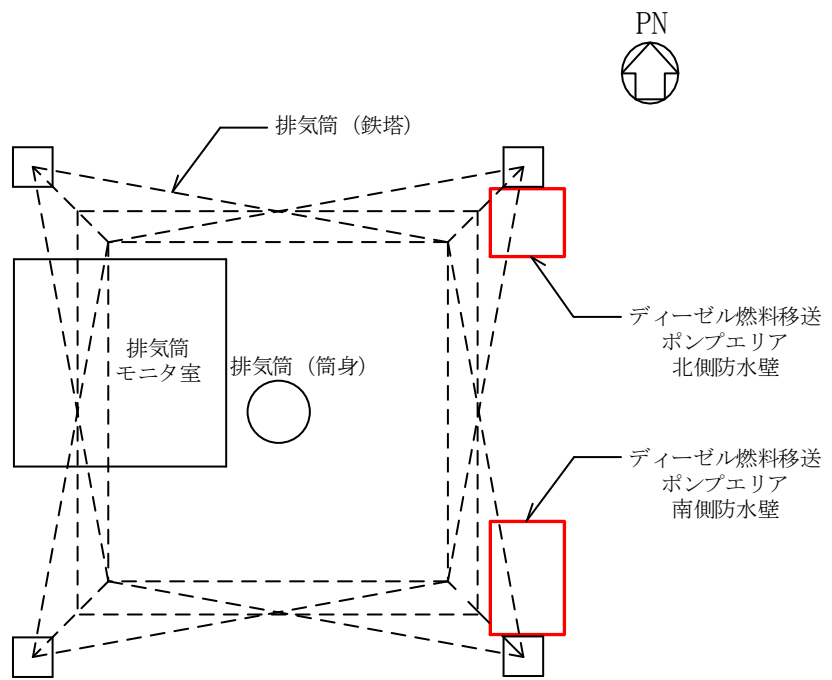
ディーゼル燃料移送ポンプエリア防水壁の配置図
